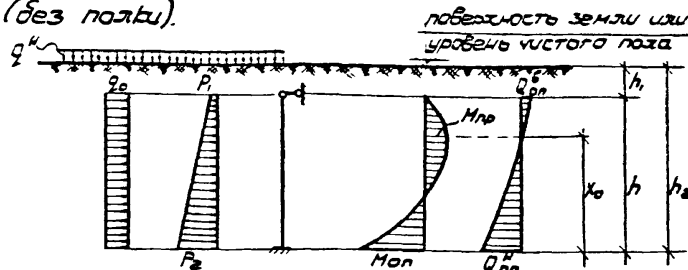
Расчетная схема вертикальной стеновой панели, нагрузки и расчетные усилия ( $M$  и  $Q$ )
